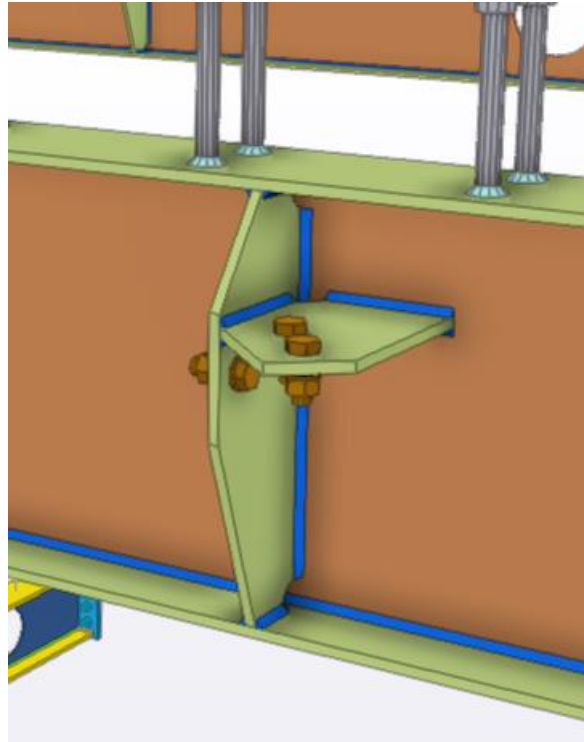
Ligação *Viga – Viga*, Utilizando Duas Chapas de Ligação Soldadas às Vigas (Fonte: Software Tekla, 2023)
